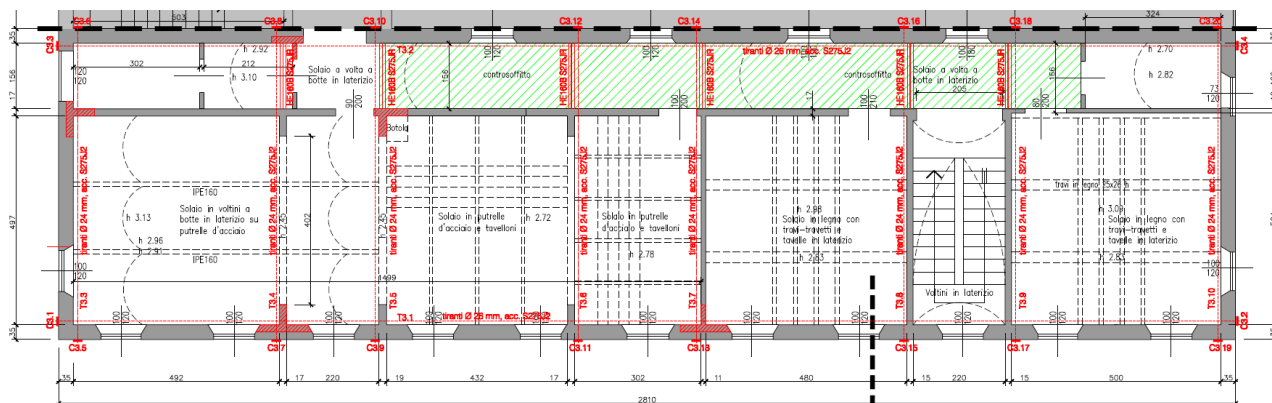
| Pianta piano Secondo – Disposizione in pianta di catene
